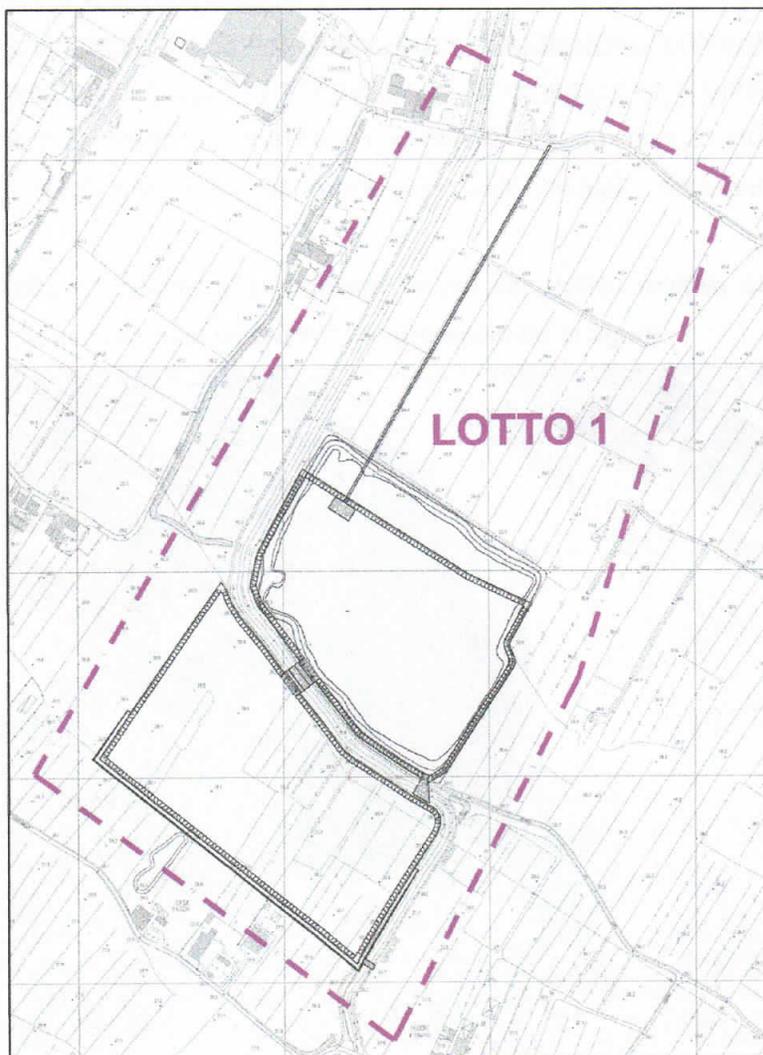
PLANIMETRIA INTERVENTI DI LOTTO 1
